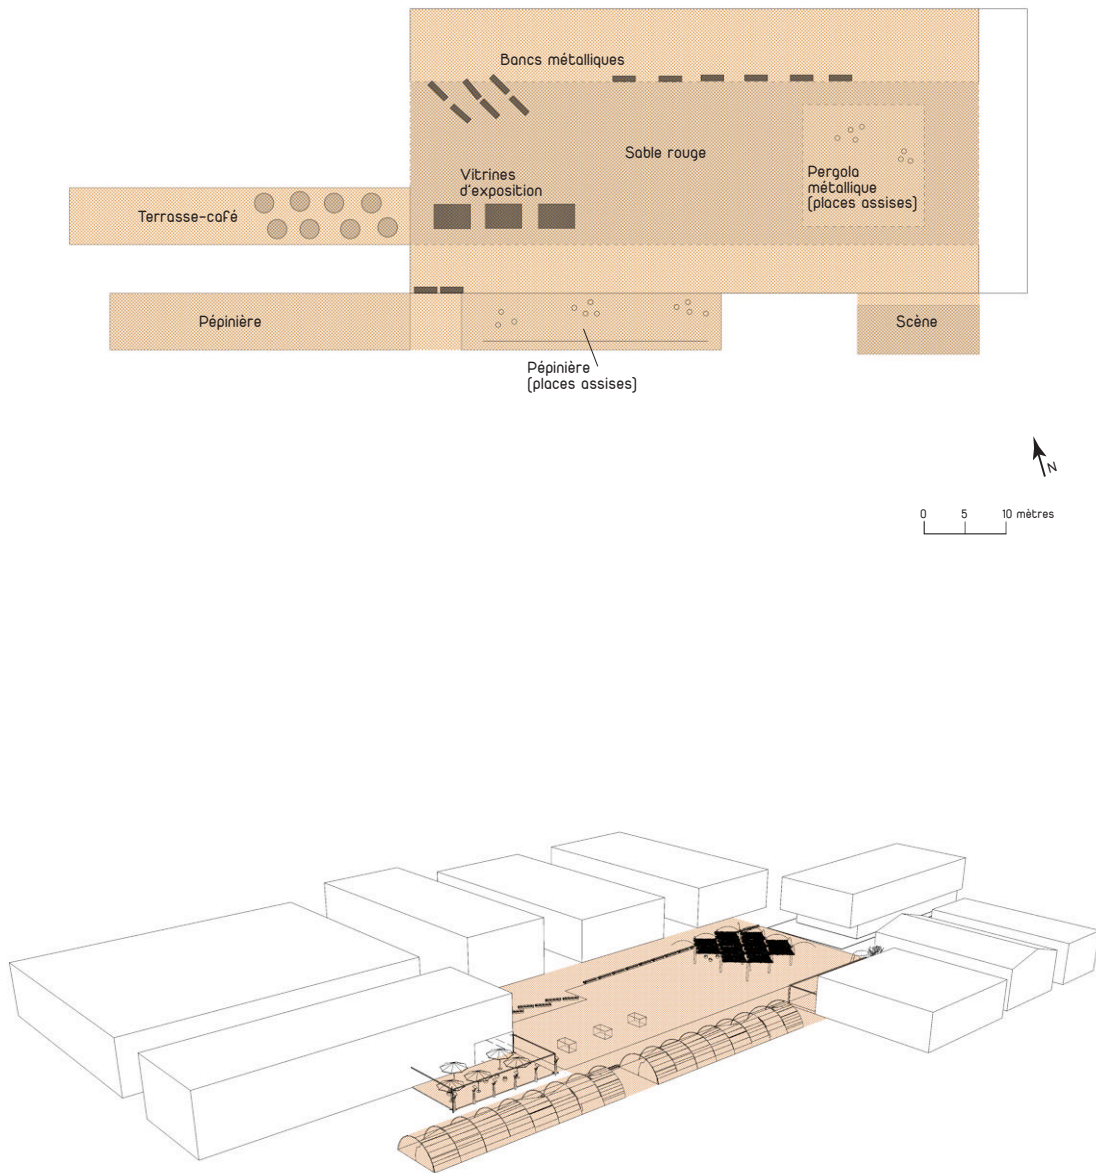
Plan de site et vue 3D de l'Esplanade (Source : Ian Losa)
